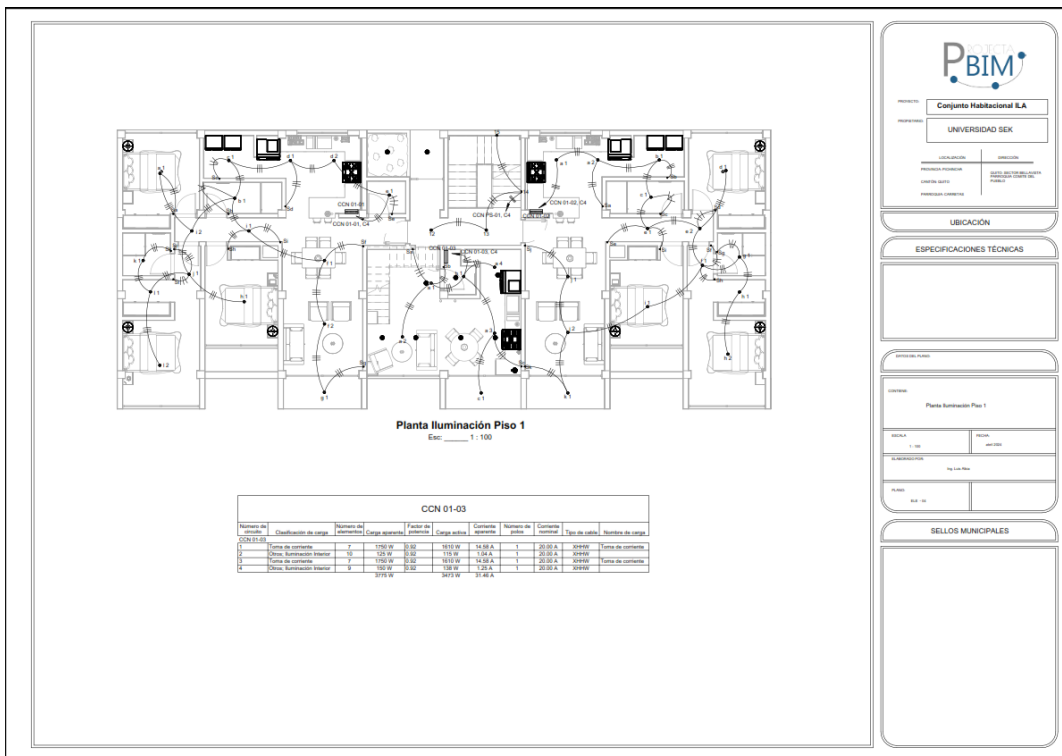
Plano Eléctrico Iluminación Piso 1 B1
